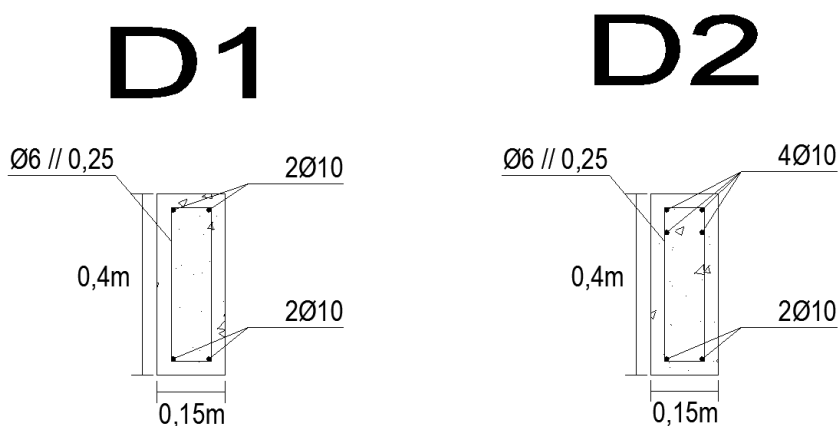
Corte transversal da viga de cobertura do pórtico 1-1'
